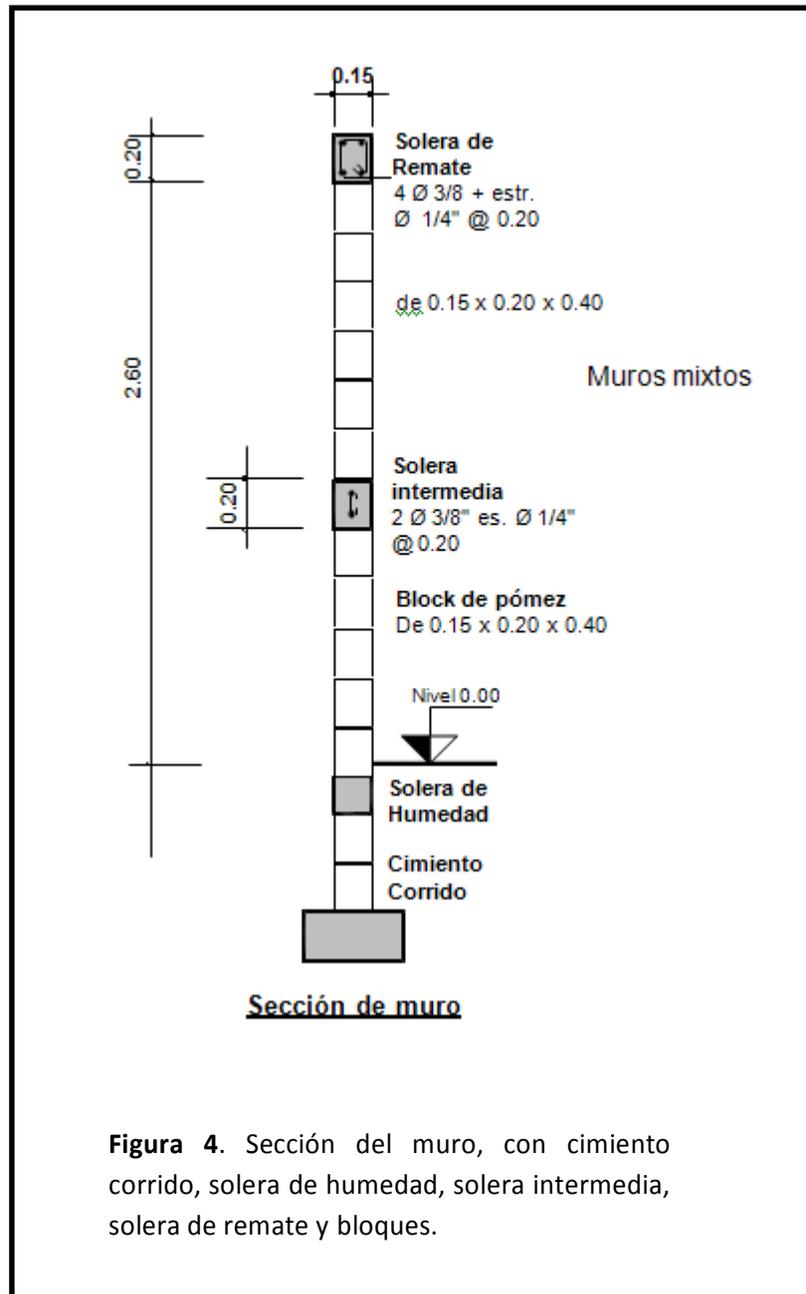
Sección del muro, con cimiento corrido, solera de humedad, solera intermedia, solera de remate y bloques.
